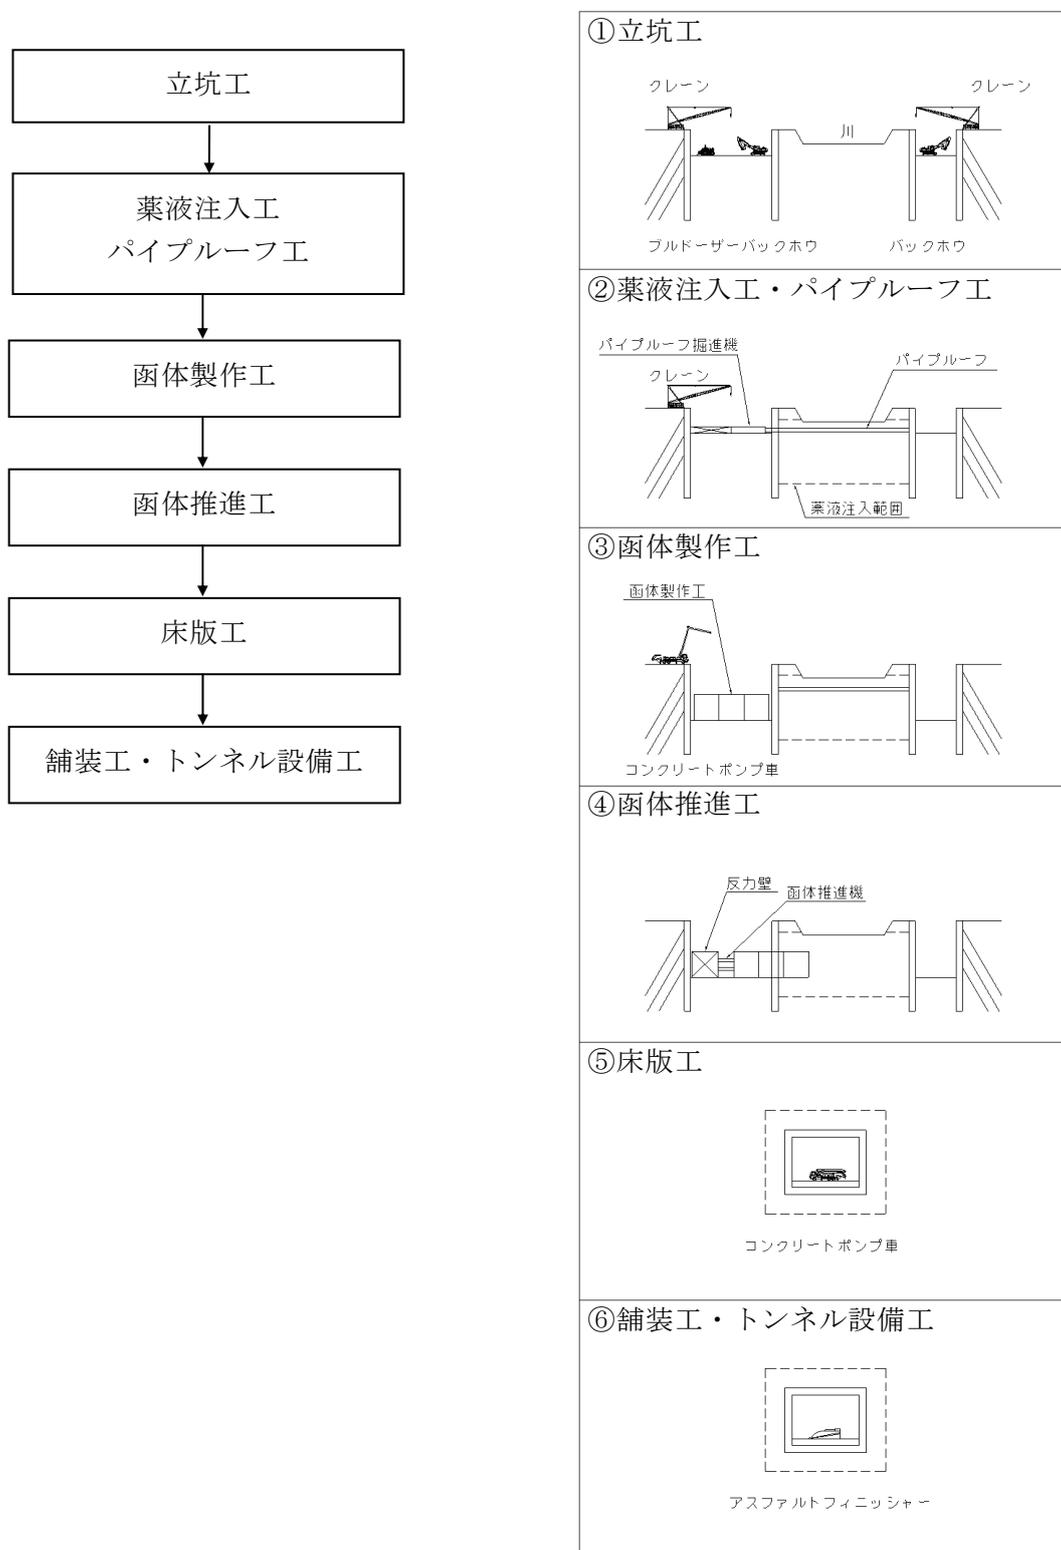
トンネル工事（函体推進工法の例）の施工順序
